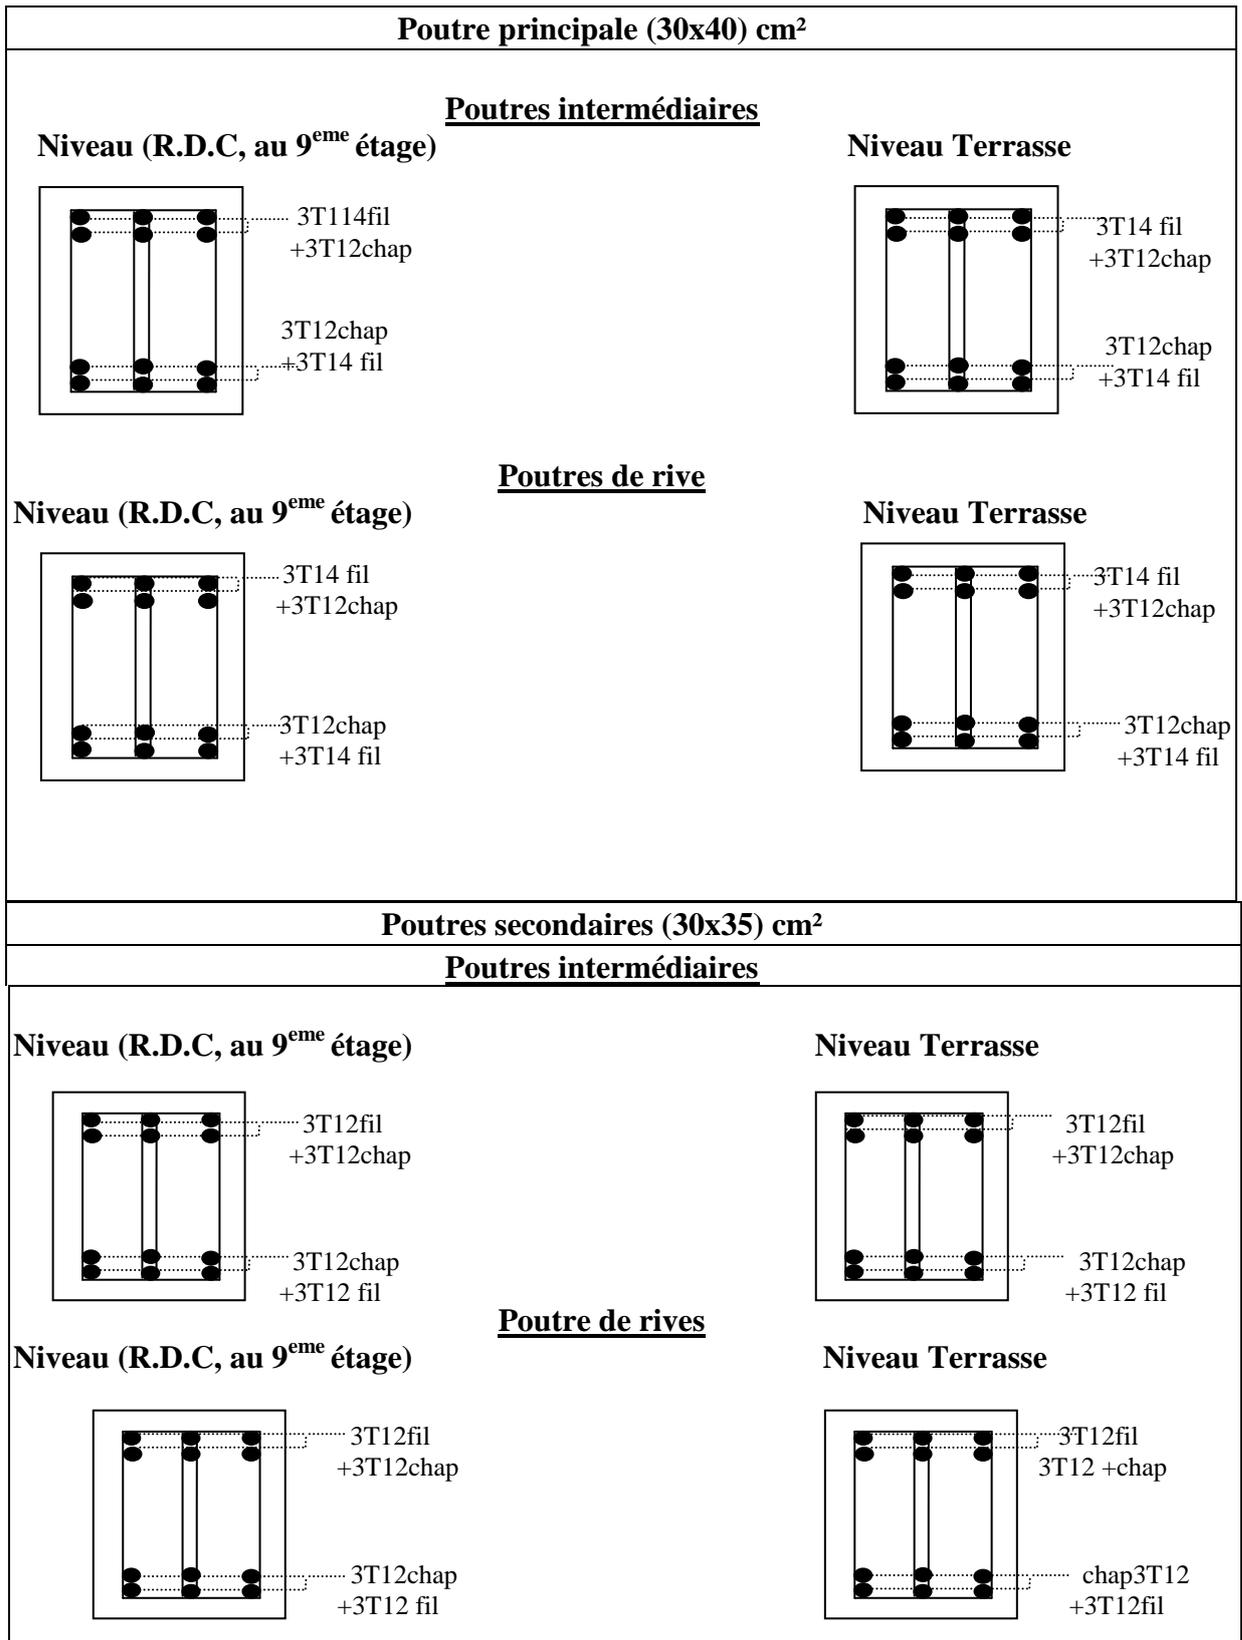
Dessin de ferrailage des sections des poutres principales et secondaires.
